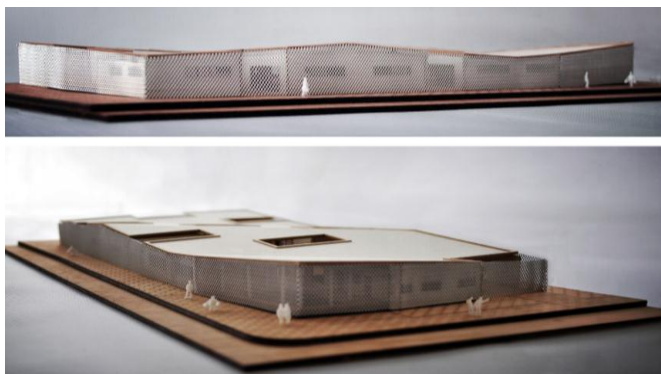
Arquitectura del proyecto a construir/Archivo planos Constructora MyS
